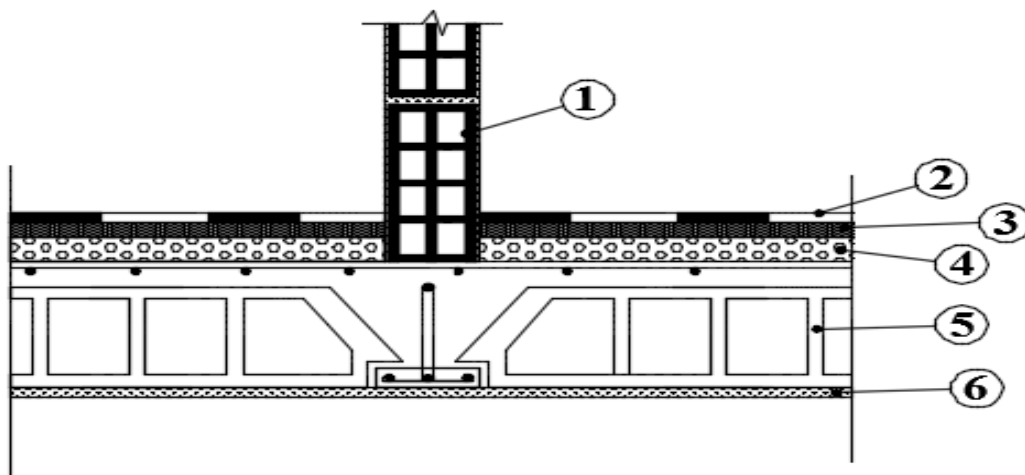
Coupe transversale au niveau de plancher étage courant.
